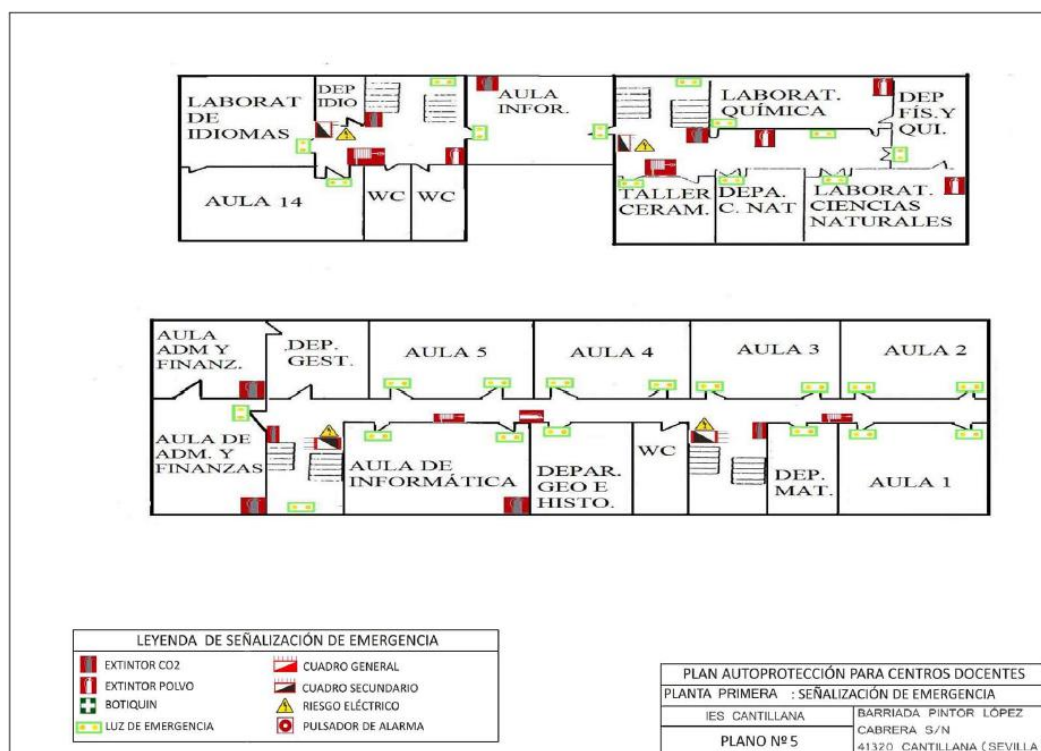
Plano de señalización de emergencia en planta primera de los edificios 1 y 2 del IES Cantillana.
